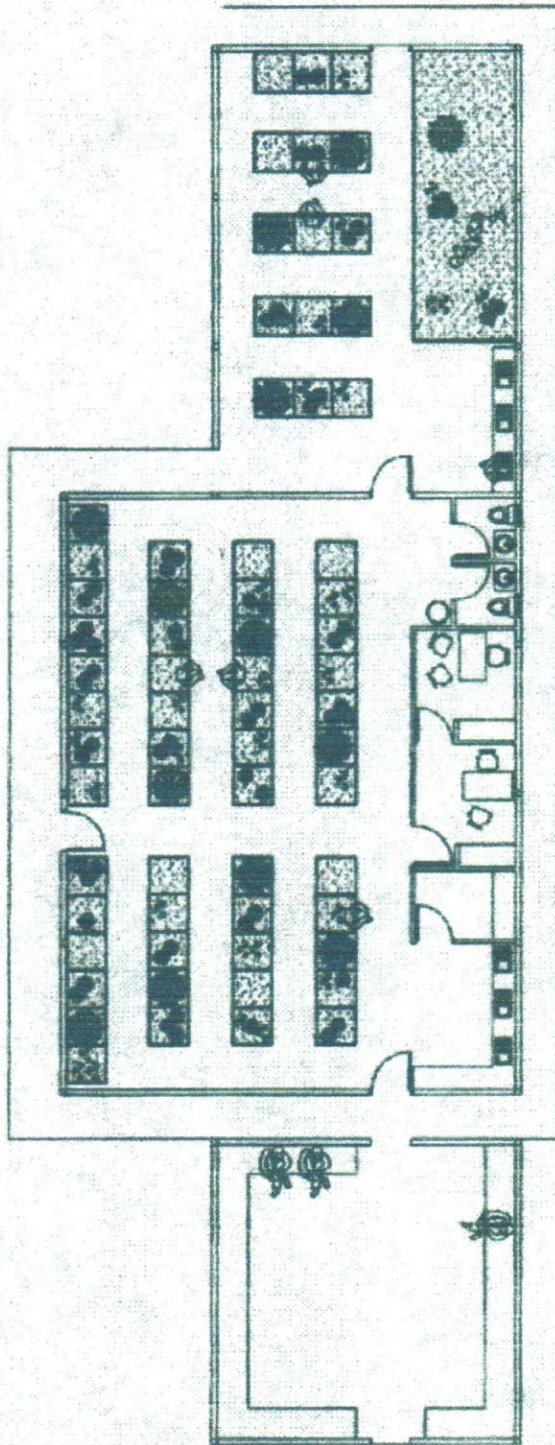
Vivero U.C.A.B.; planta de distribución interna.
